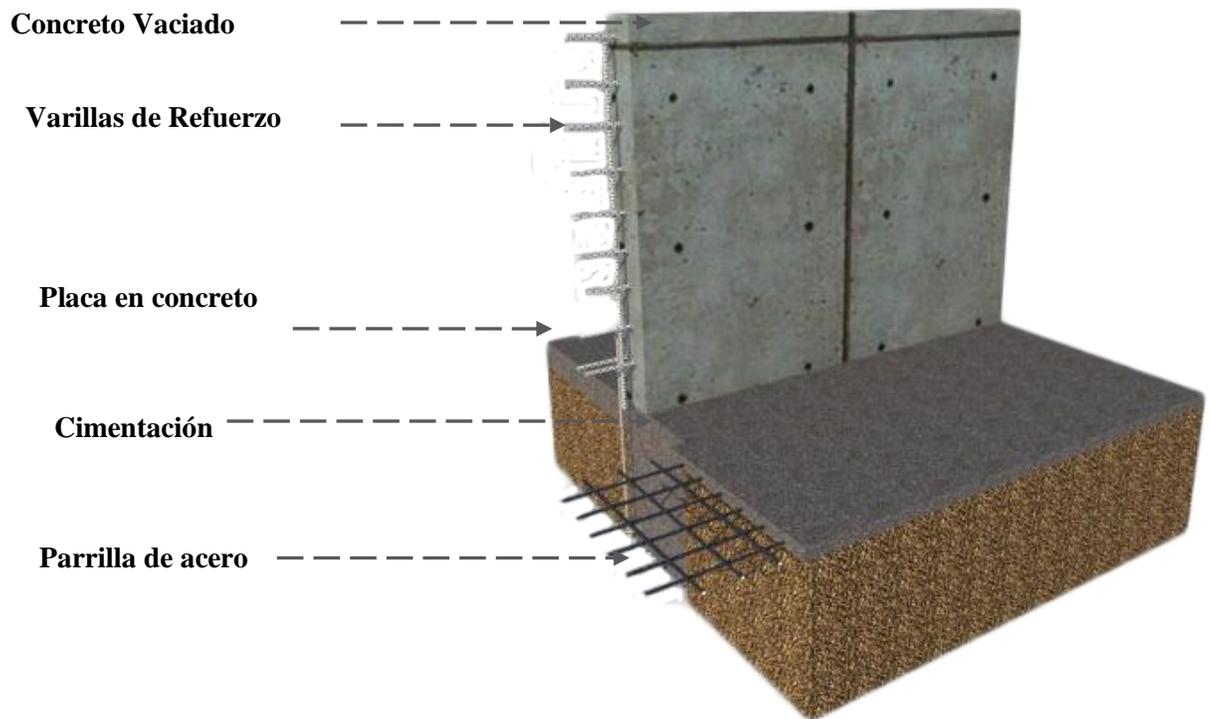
Detalle fundición de muro estructural- Sebastian Monroy-2014- Detalle Constructivo
